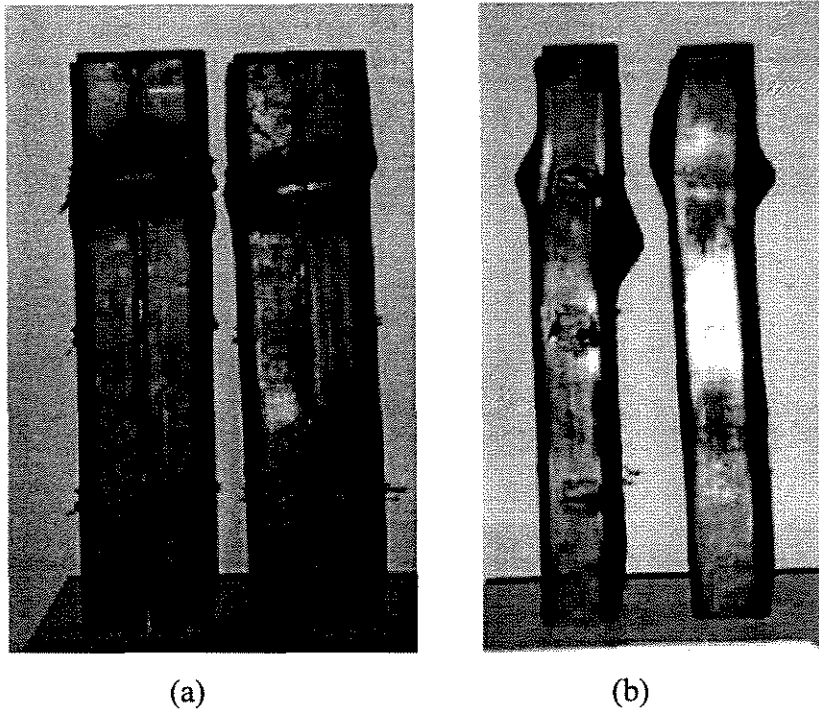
Pilar PR50-II=lado esquerdo, pilar PQ50-I=lado direito
